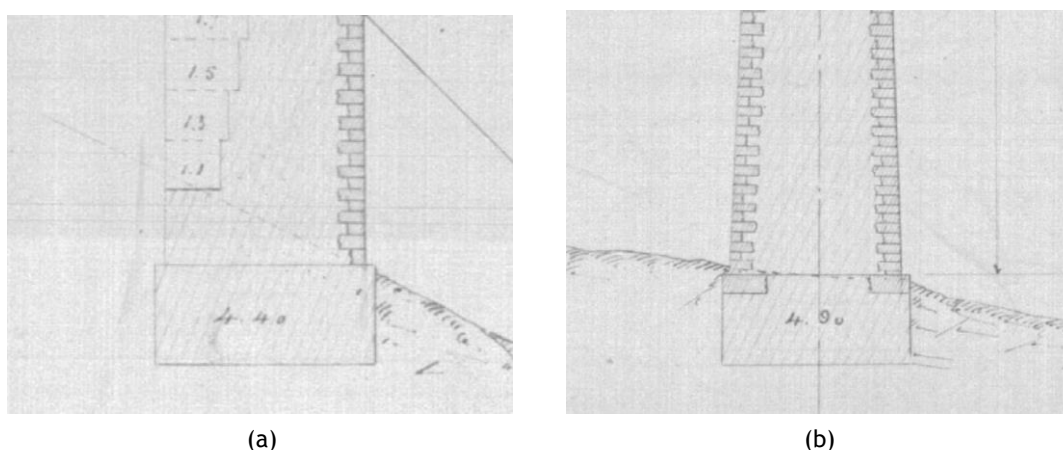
Fundações da Ponte do Corge (adaptado de [60]): (a) Sapata no encontro E1; (b) Sapata no pilar P2
